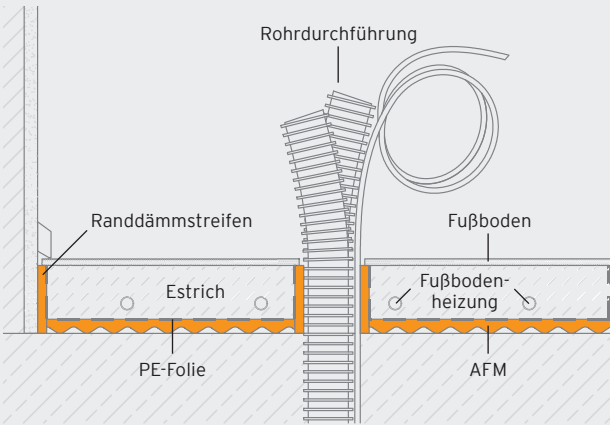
Ausführungsdetail mit beheiztem Nassestrich
